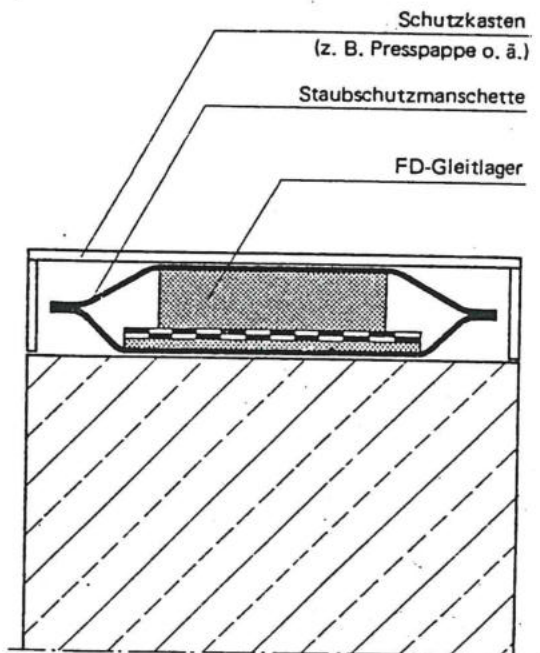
Verlegung der FD-Gleitlager bei Ortbetonbauweise. Querschnitt
